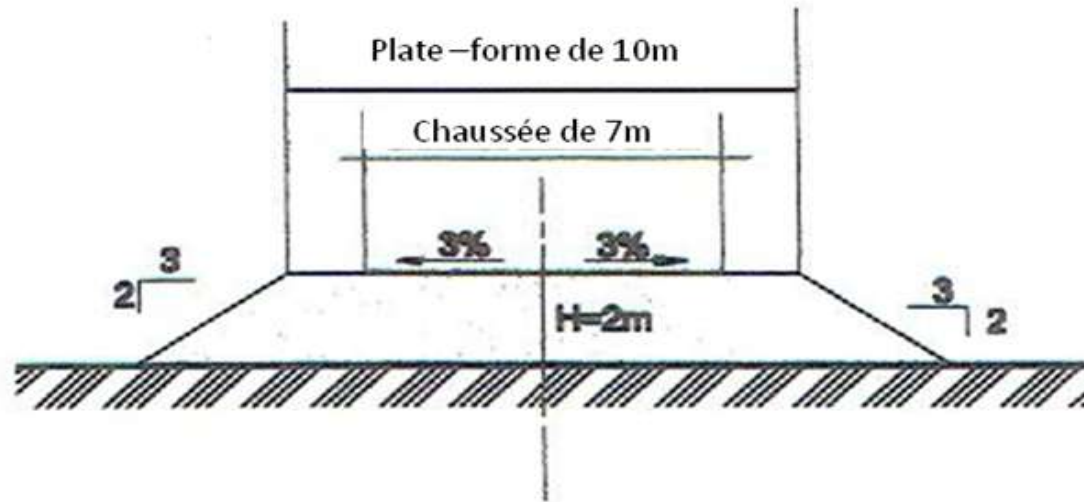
Profil d'équilibre de la route sans protection, la pente de la chaussée a été de 2/3 (ECH : 1/200)
